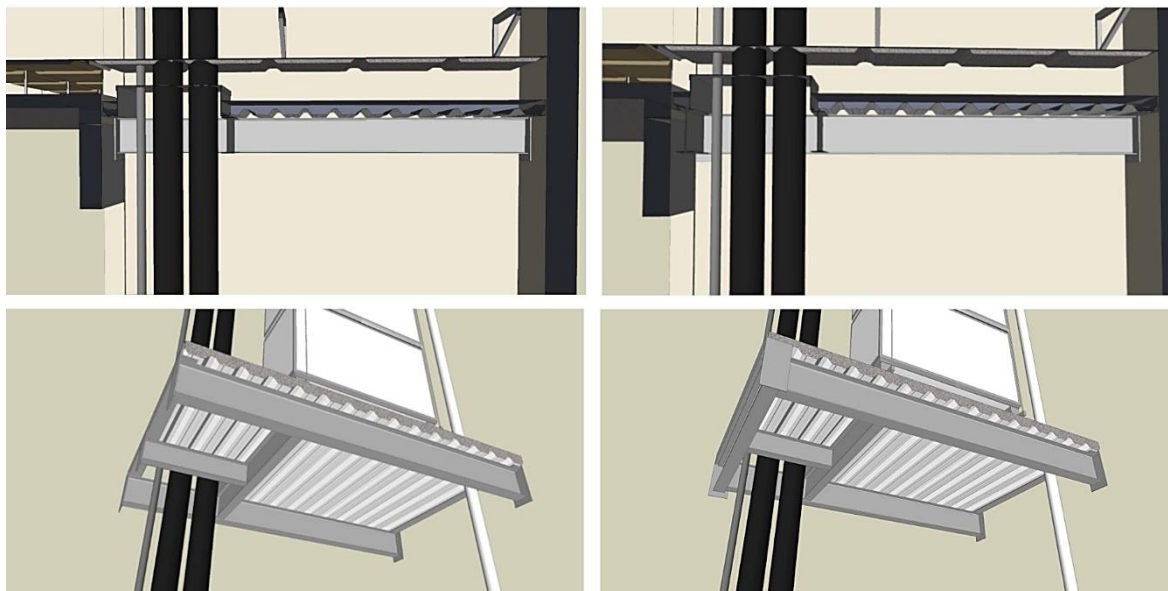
Laje steel Deck – Situação de projeto X Proposta de modificação.
